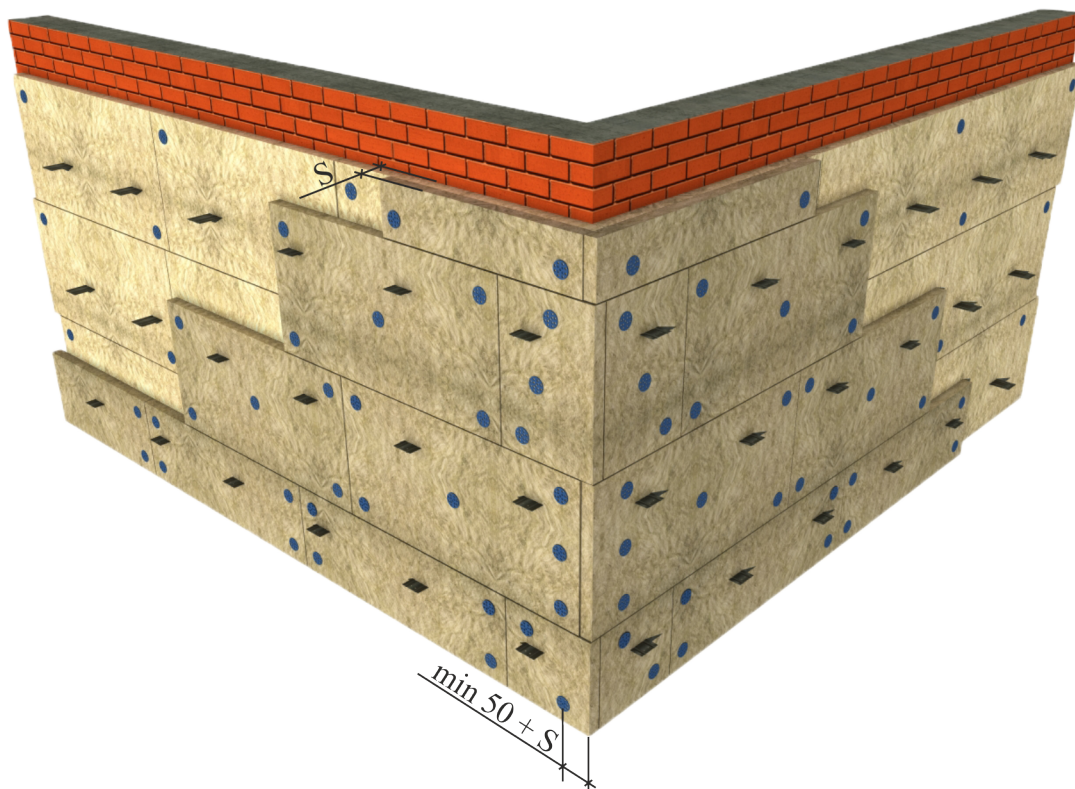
Схема крепления в угловой зоне наружного слоя при двухслойном утеплении.
